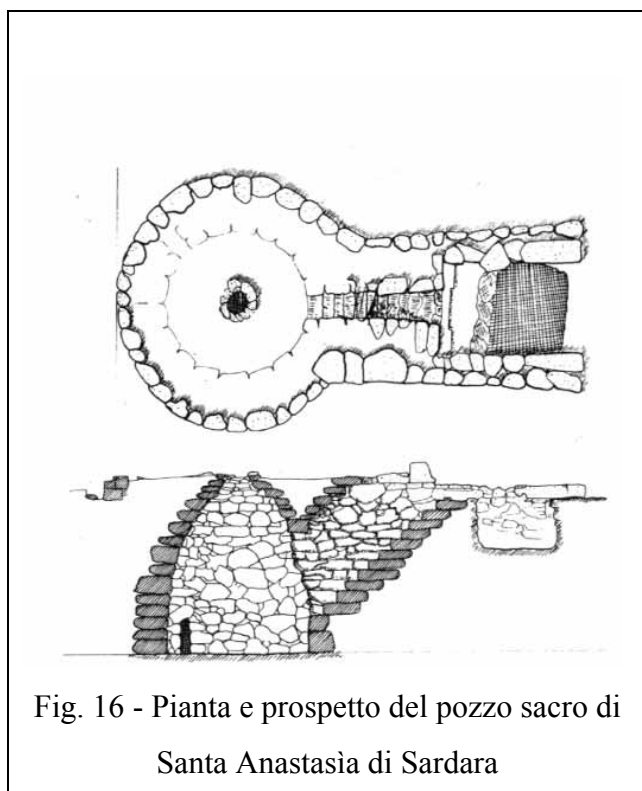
Pianta e prospetto del pozzo sacro di Santa Anastasia di Sardara
